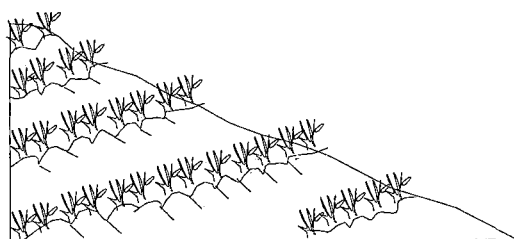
Sembrado de Plantas en el Borde Superior de las Zanjas de Infiltración.
